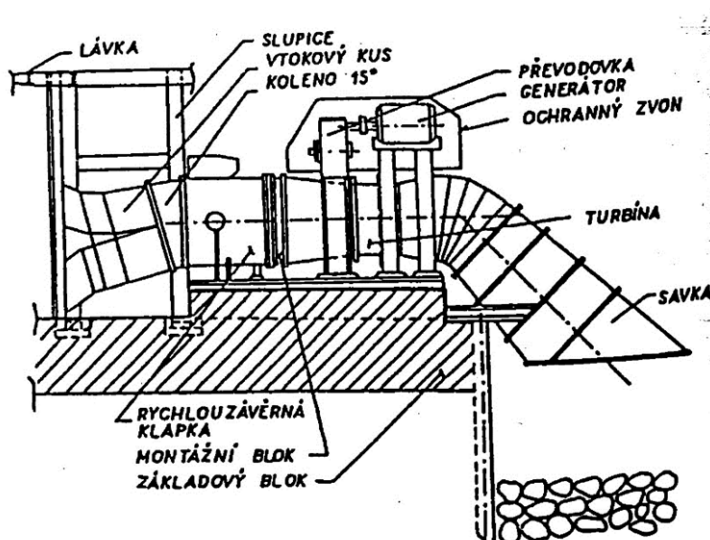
Přímoproudá turbína s vnějším generátorem [6]
